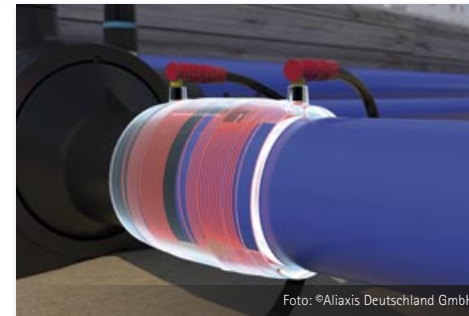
Verfahren: Heizwendel-Schweißen
